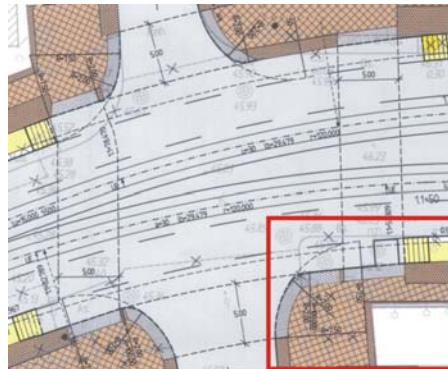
Lageplan „Fehlende/zu geringe Aufstellfläche“
